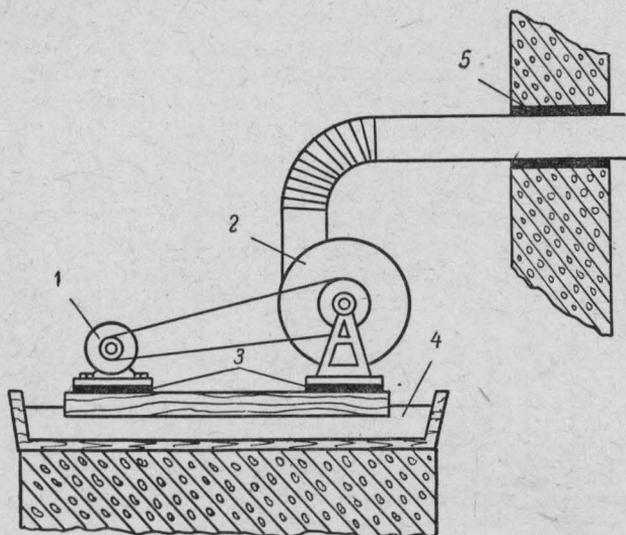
Схема звукоизоляции вентиляционного агрегата:
